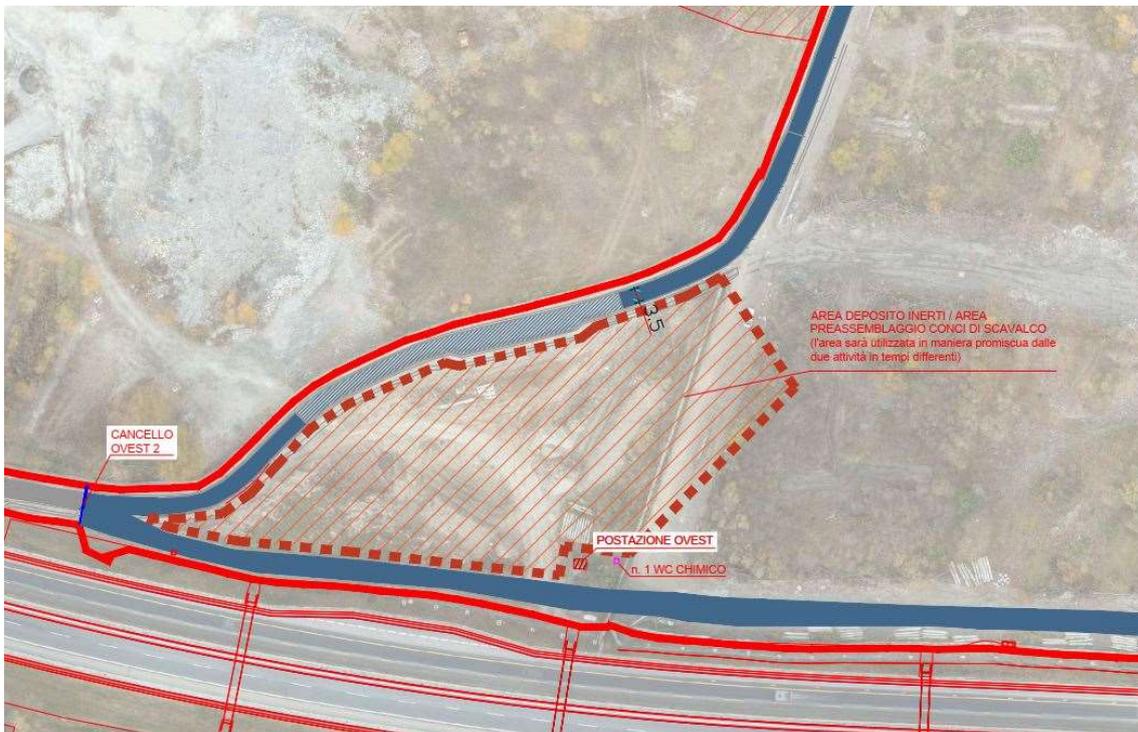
Area deposito inerti e preassemblaggio conci di scavalco – area ovest
